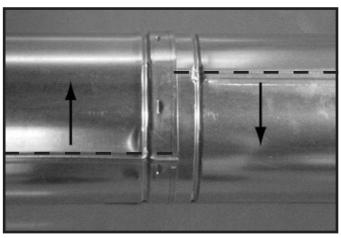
Tourner les cordons de soudure pour démonter
